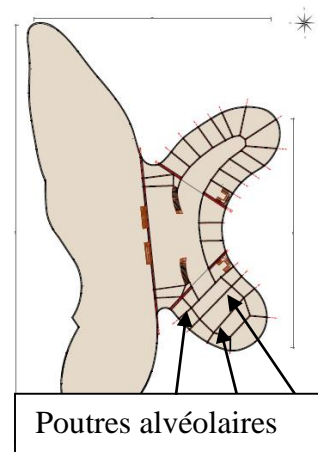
Poutres ACB® dissymétriques dans l'application "plancher"
